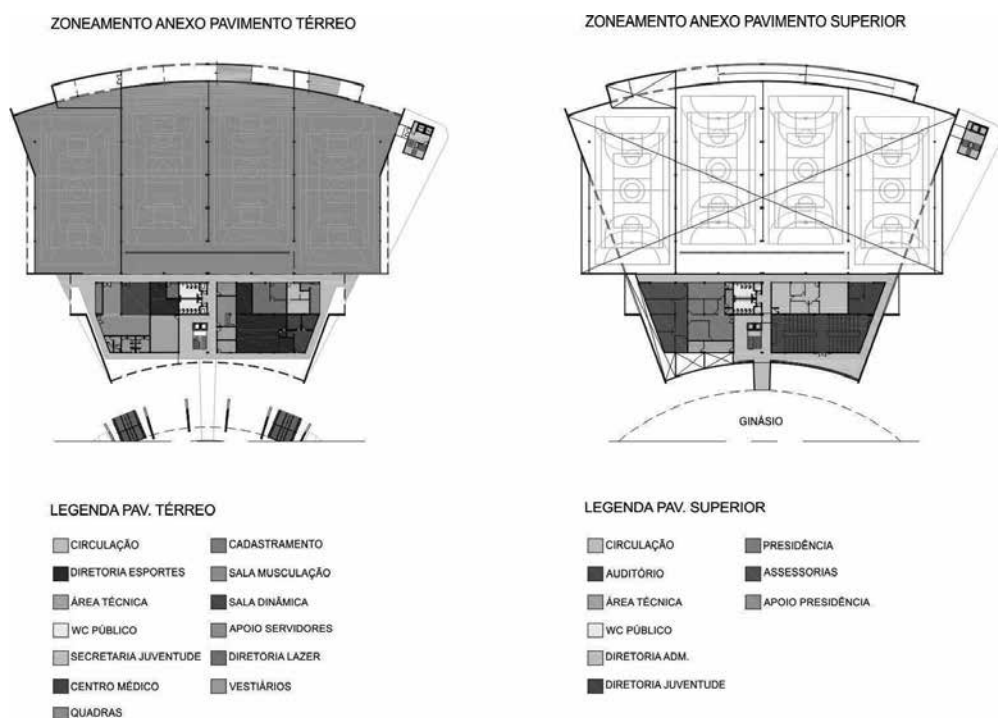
Planta esquemática do prédio anexo. Fonte: Produção Arquitetura.
